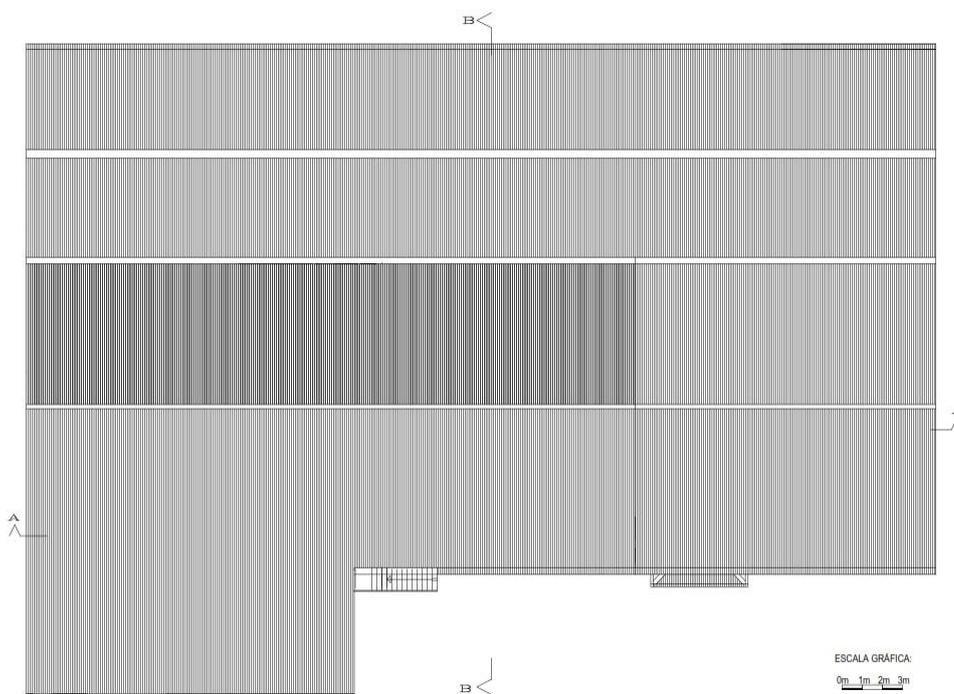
Adega Quinta da Vinha – Planta da Cobertura⁵⁶
